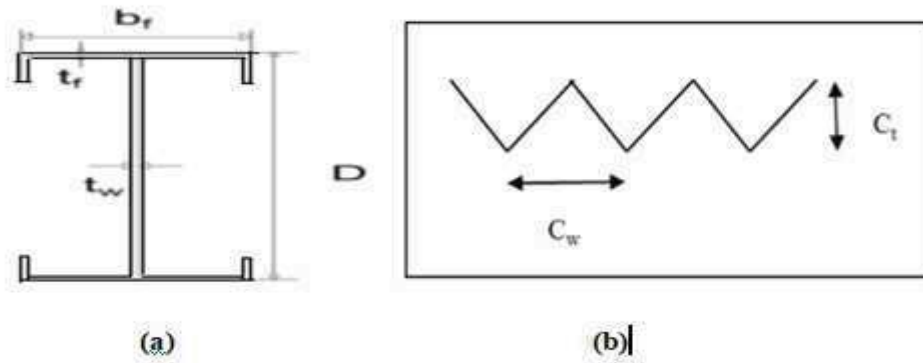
Présentation des sections transversales des poutres étudiées.
